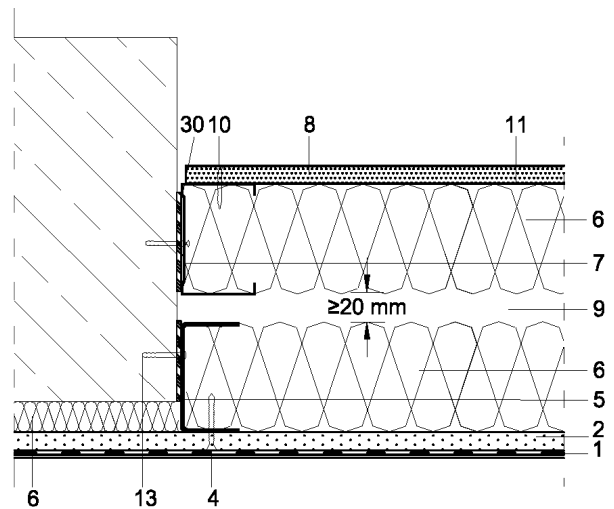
Encuentro con pilar del sistema de doble hoja.
